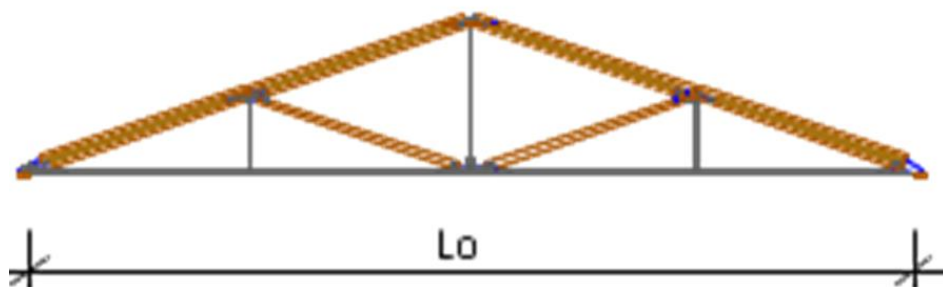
Четырехпанельная ферма треугольного очертания
